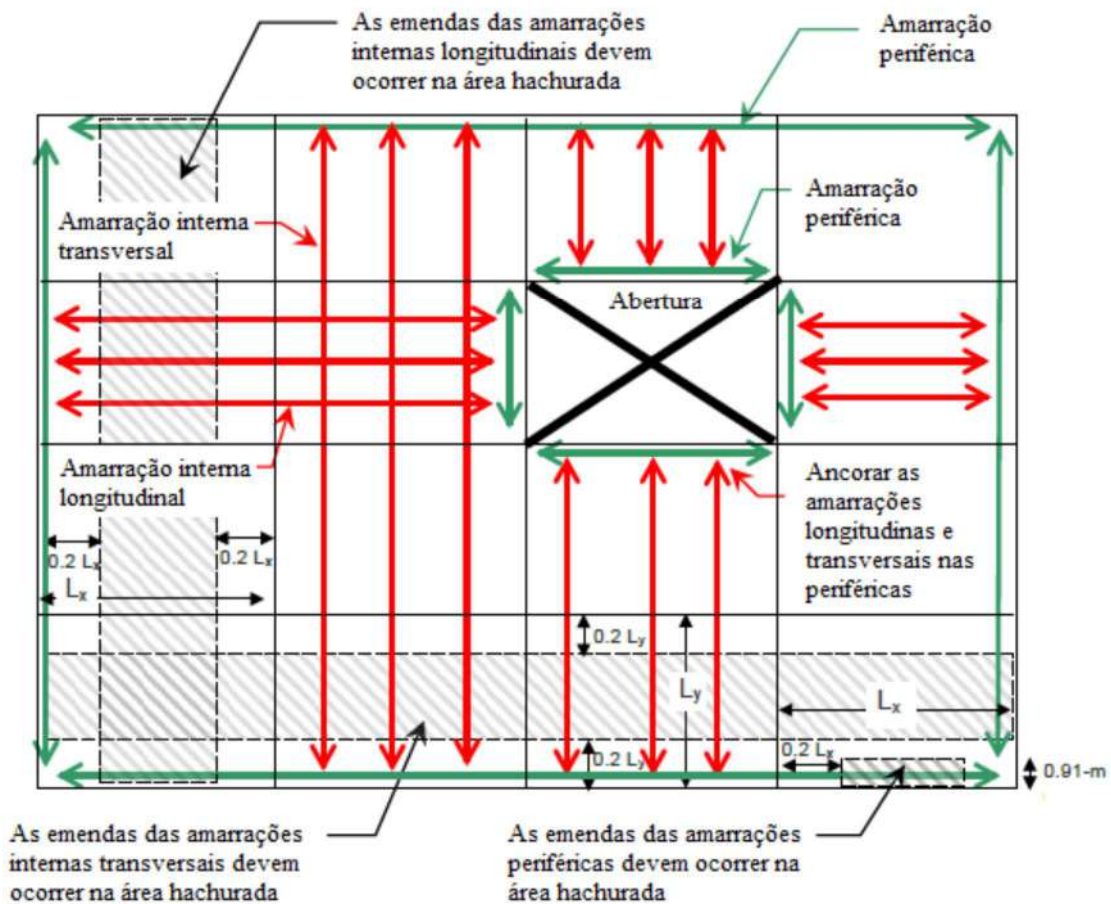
Locais de interrupção e disposição dos tirantes (adaptado de DOD, 2016)
